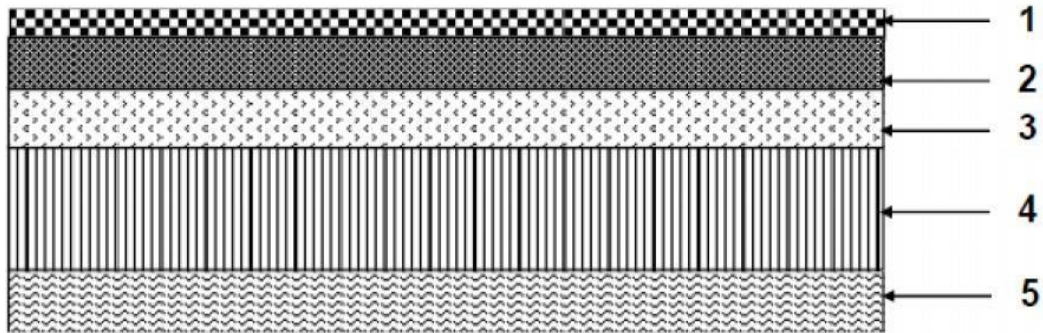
Coupe du plancher terrasse inaccessible en corps creux
